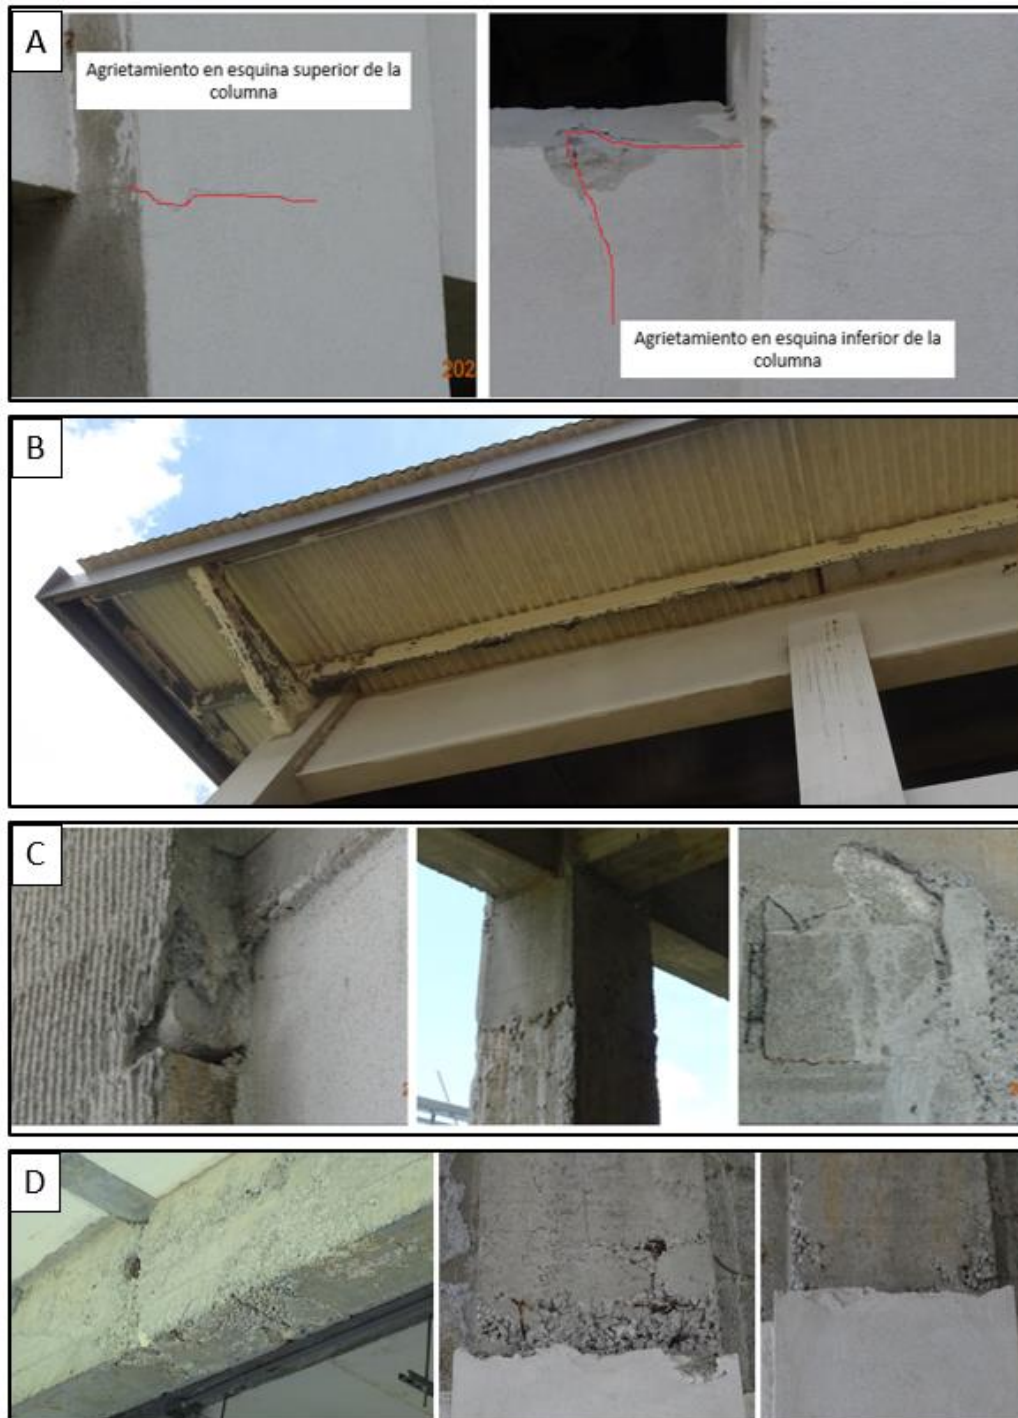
Deficiencia constructiva de (A) Agrietamiento en esquinas de columnas, (B) Perdida de protección anticorrosiva en cerchas de techo, (C) Desprendimientos de concreto,
